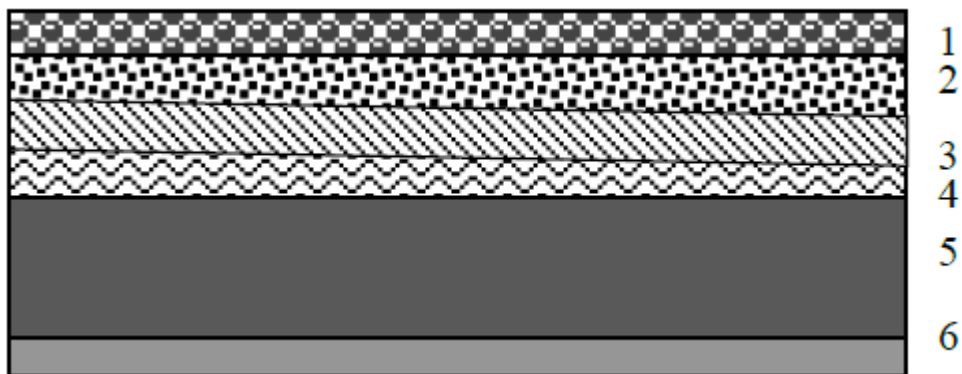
Coupe verticale du plancher terrasse à dalle pleine.
